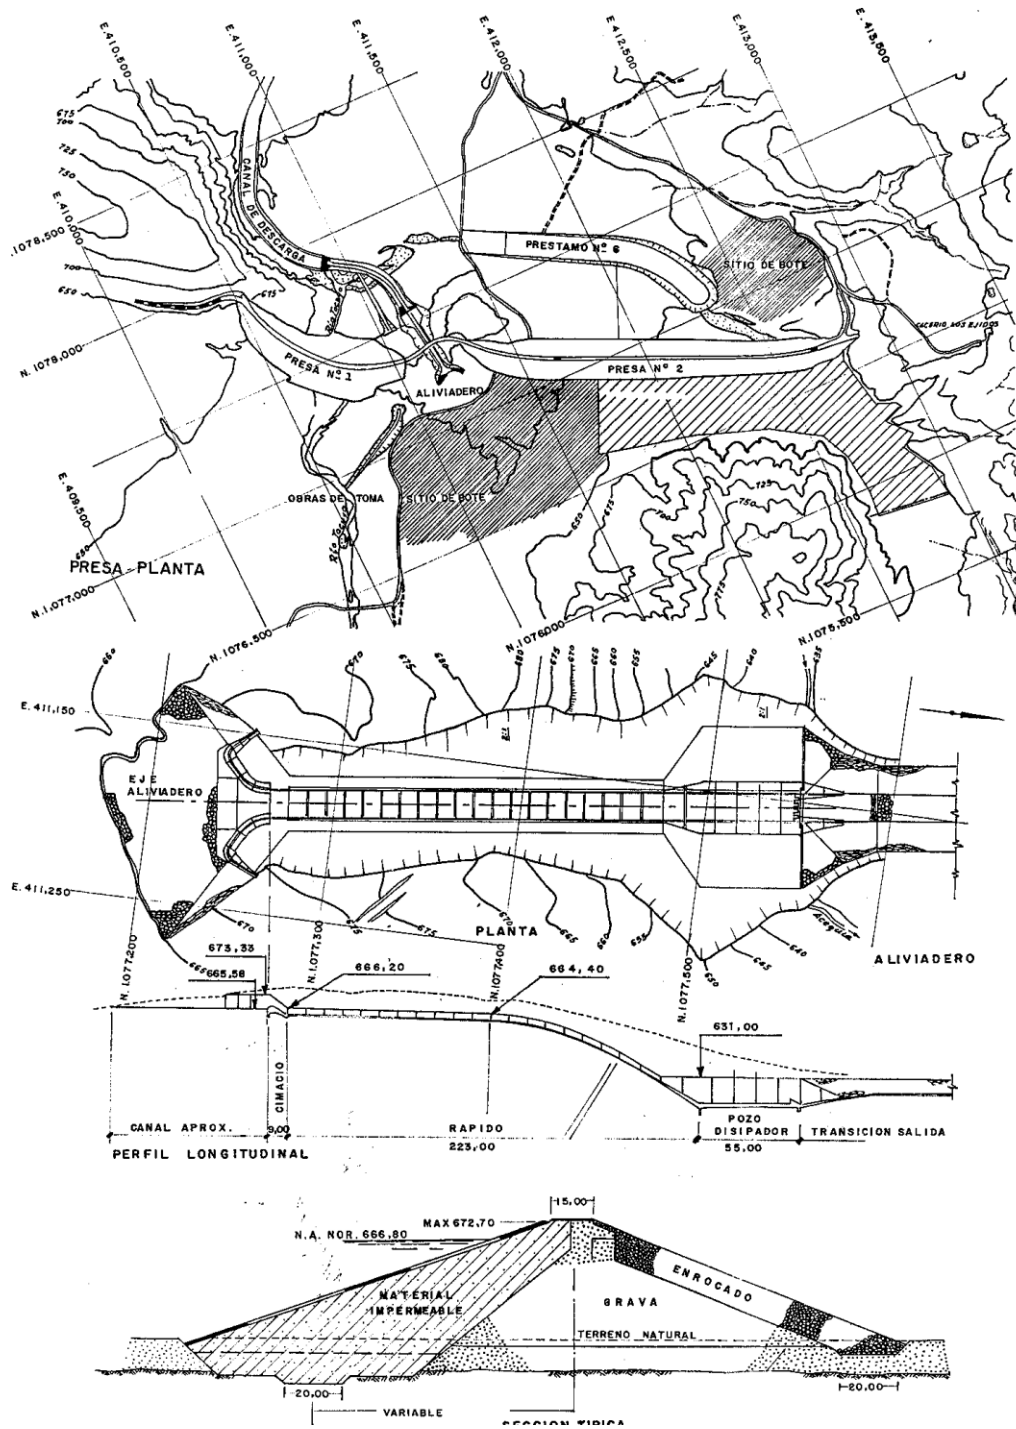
Plano de Plata de la Presa. Plano de Planta y Perfil Longitudinal del Aliviadero. Sección Típica de la Presa. Embalse Dos Cerritos. Fuente: Revista El Agua (1976).
